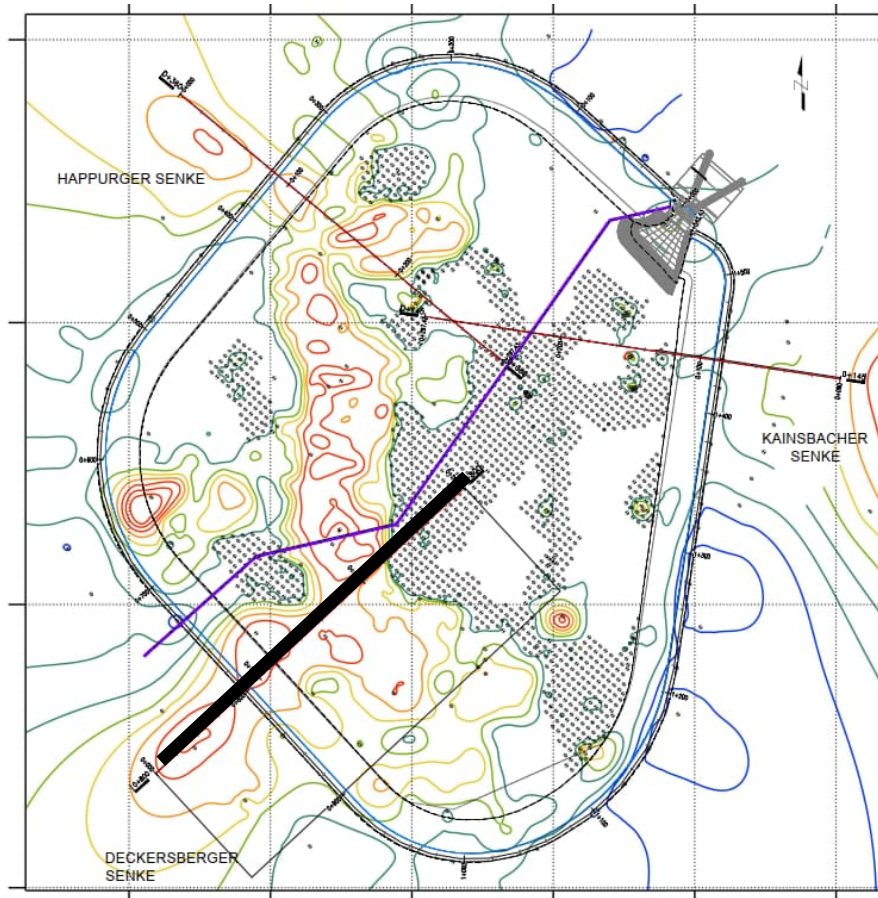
Übersicht Berechnungsschnitt im geologischen Lageplan
